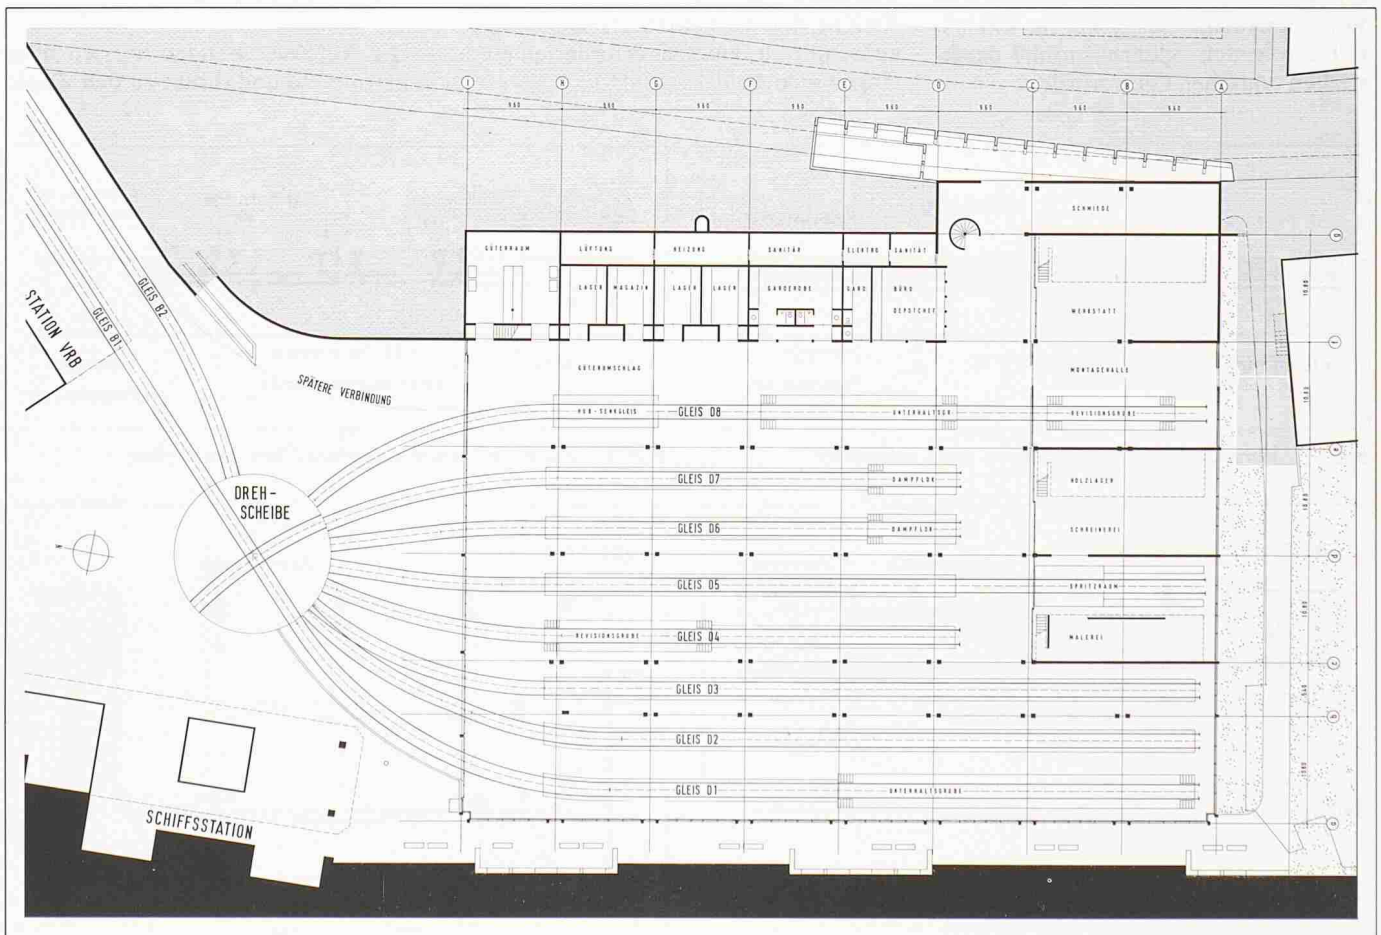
Gleiskonzept. Grundriss EG mit Gleis D1–D8, inkl. Gruben. Drehscheibe mit Kreuz. Proj. Verbindung D8–Berggleis B2
